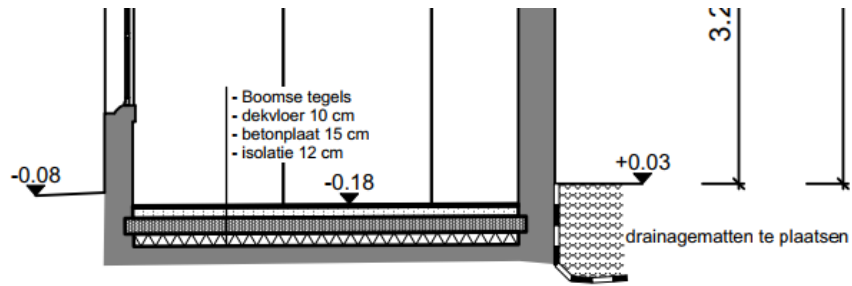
Kelderplan toekomstige inplanting Sint-Margaretastraat 29 – Hellestraat ³⁶
